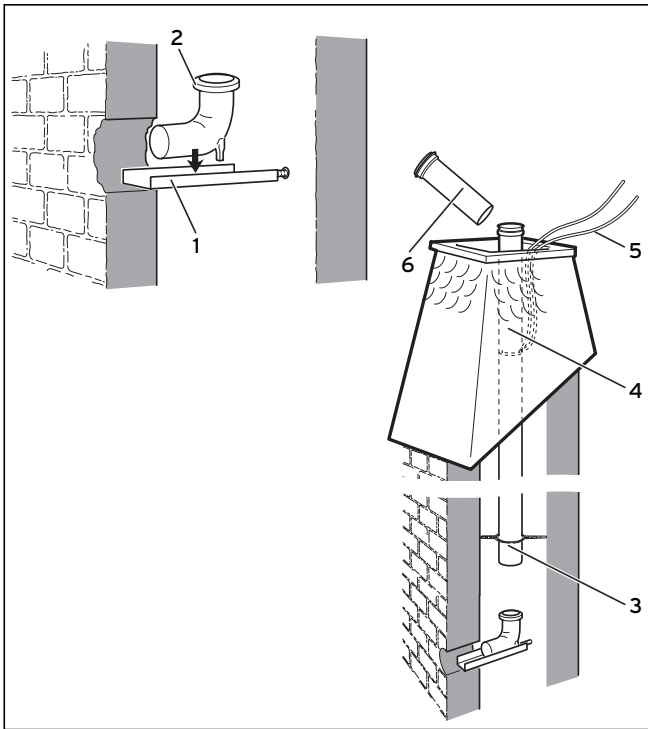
Montaggio della tubazione fumi rigida nel pozzo
